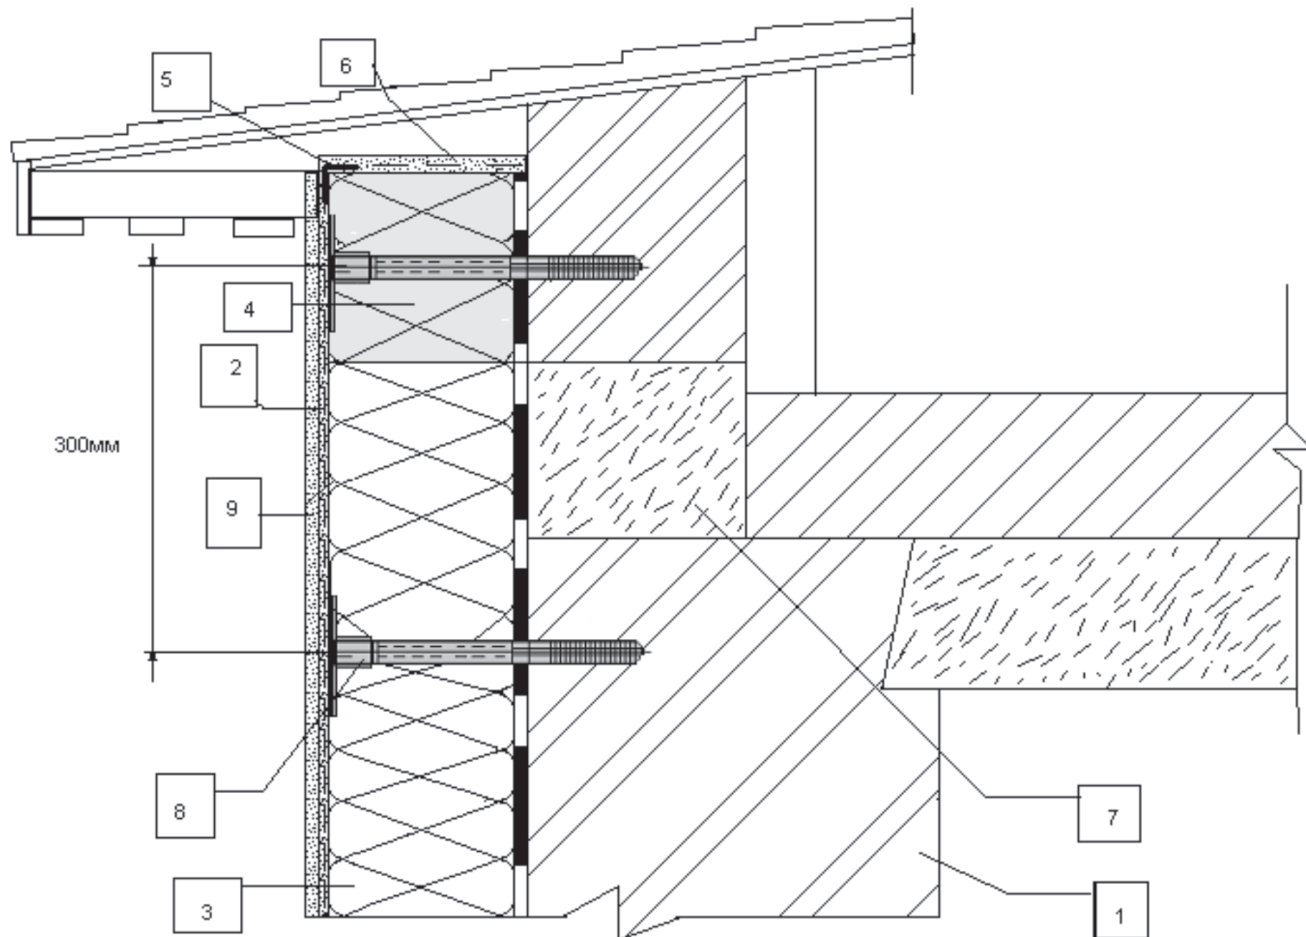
Фрагмент примыкания системы скрепленной теплоизоляции к скатной кровле:
